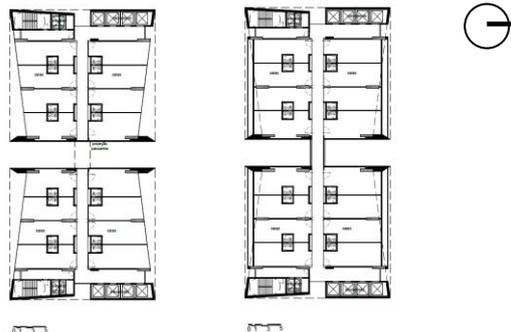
Desenhos Técnicos: Planta Tipo 1 e Tipo 2 Empresarial Acácio Gil Borsoi.
